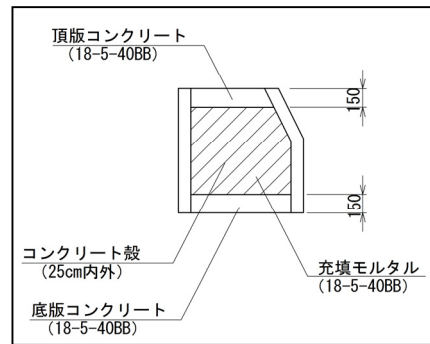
(2) プレキャスト基礎工（殻投入タイプ）の例
